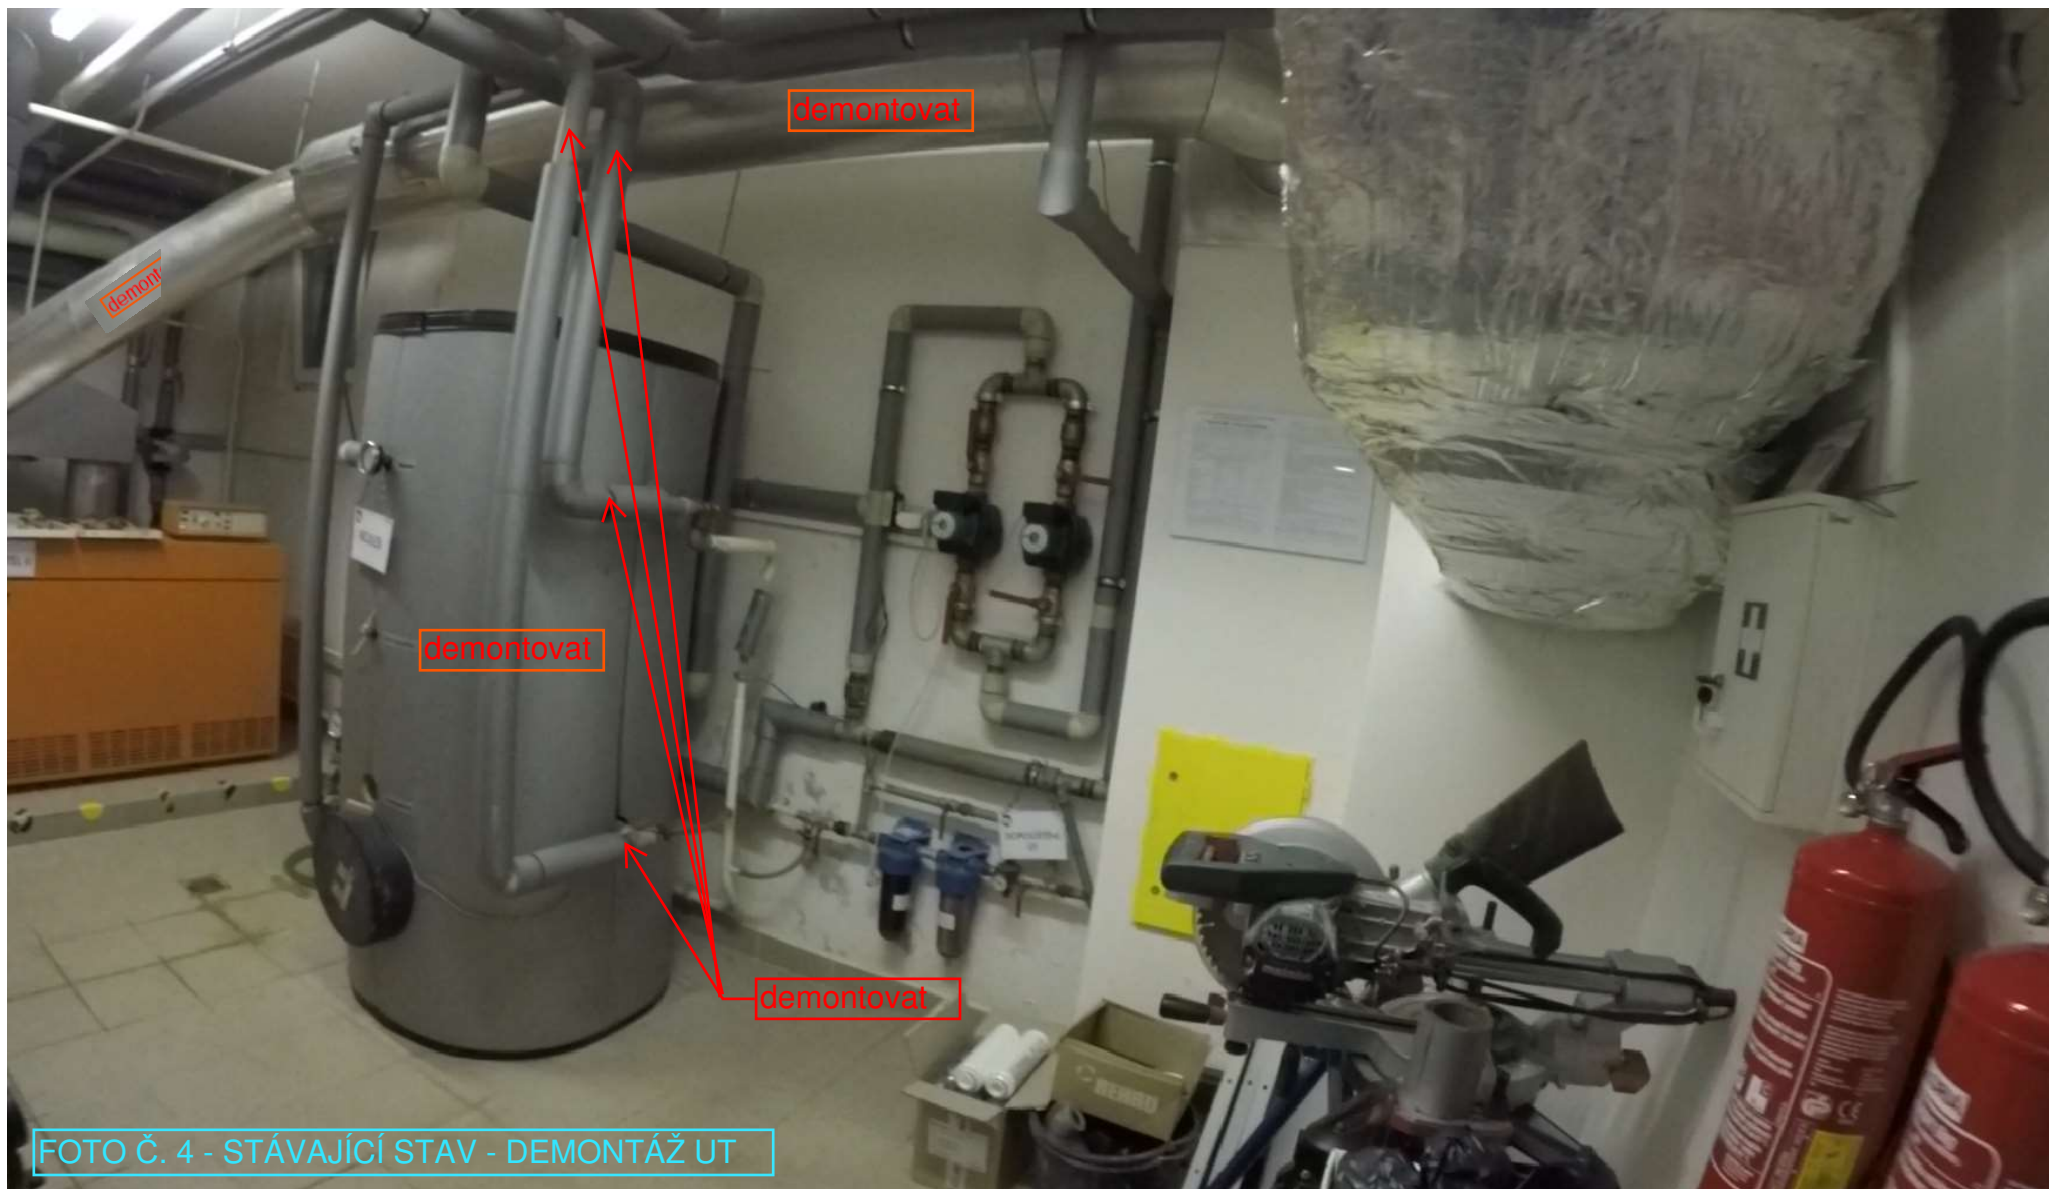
STÁVAJÍCÍ STAV - DEMONTÁŽ UT
